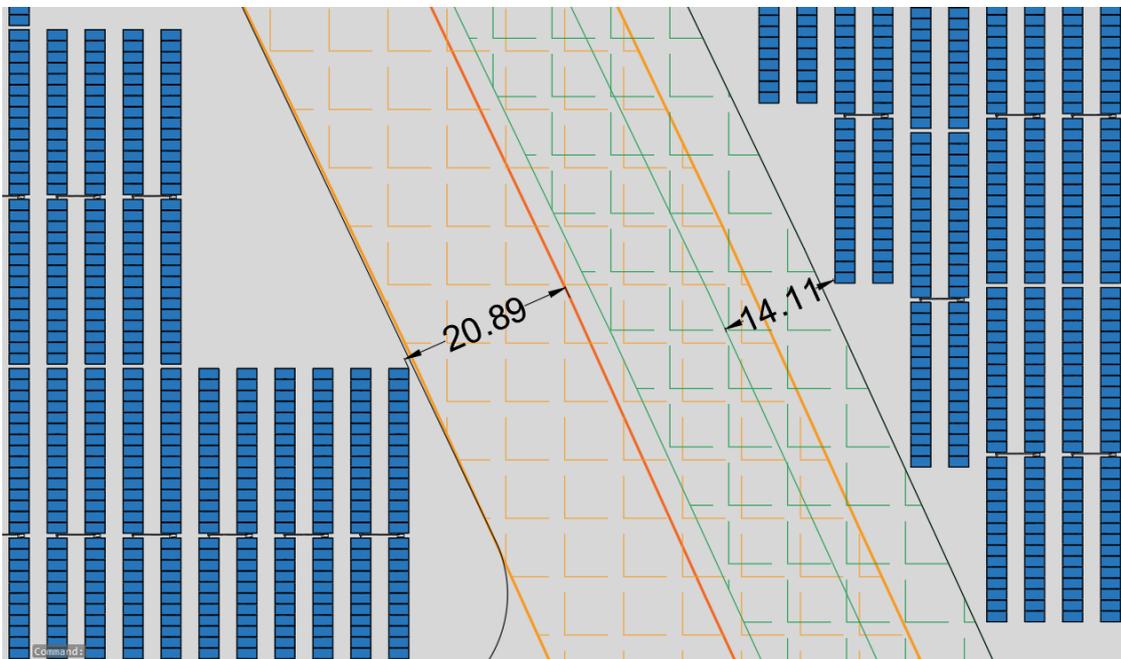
Layout Impianto con indicazione distanze di rispetto condotta SNAM
